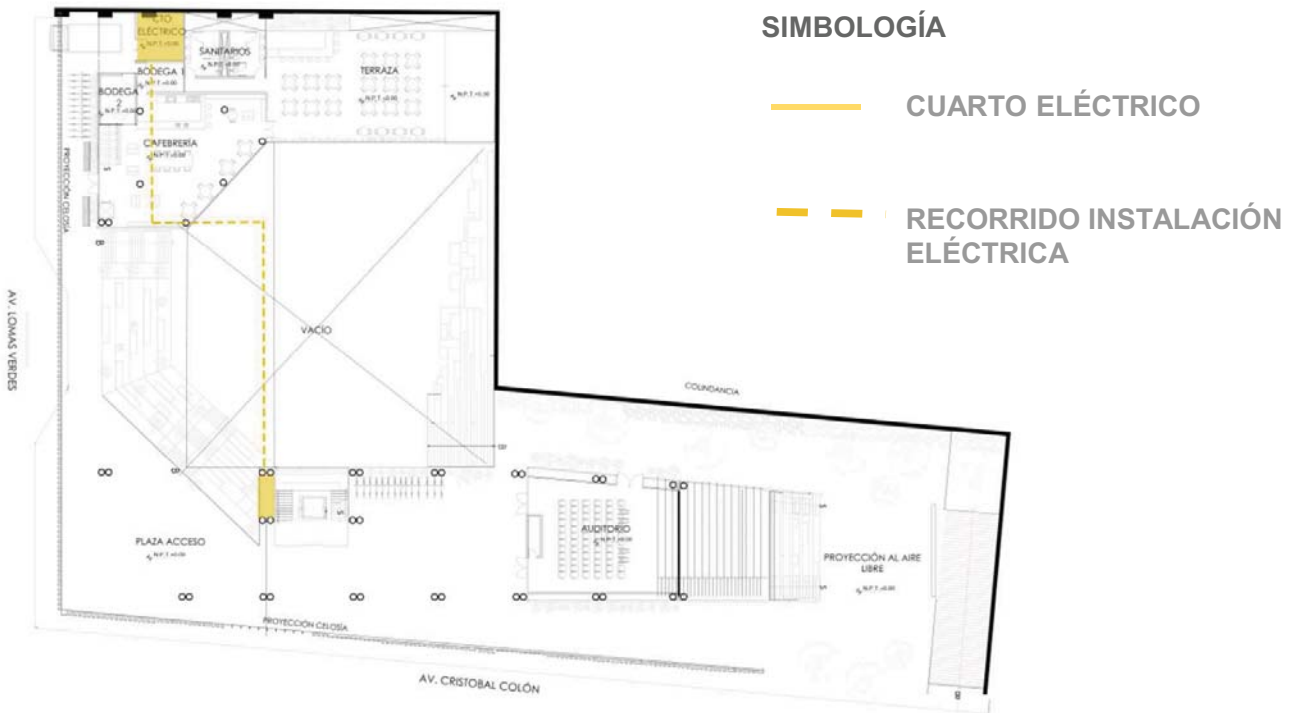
Planta esquemática de instalación eléctrica, [elaboración propia].
